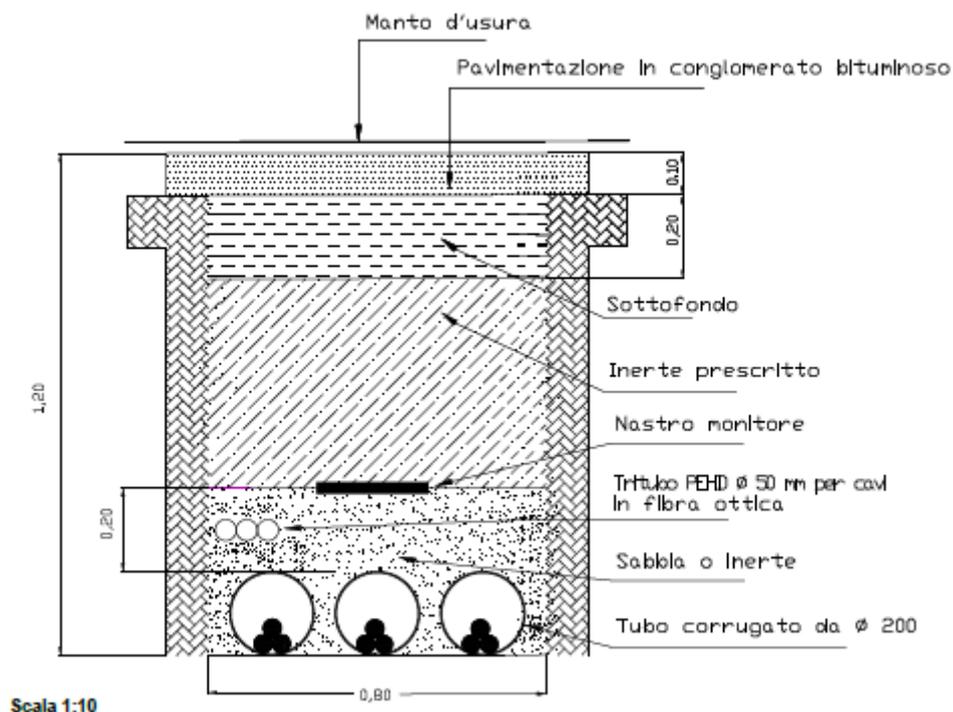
Sezione su strada asfaltata - posa di n°3 cavi MT
